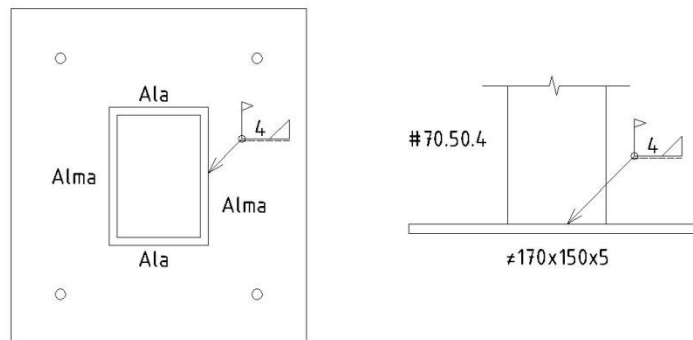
Soldadura perfil de la sección y la placa
